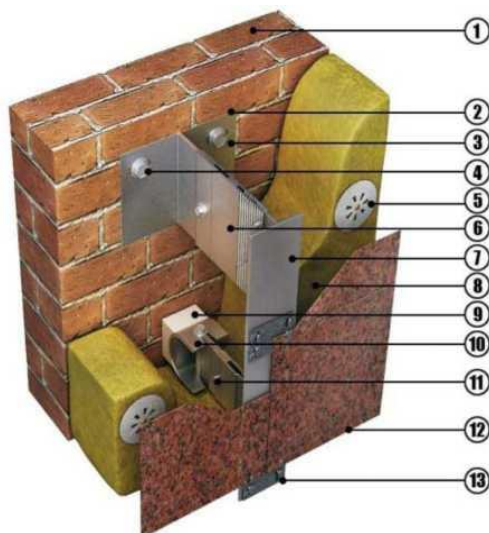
Конструкція начіпного вентиляваного фасаду
